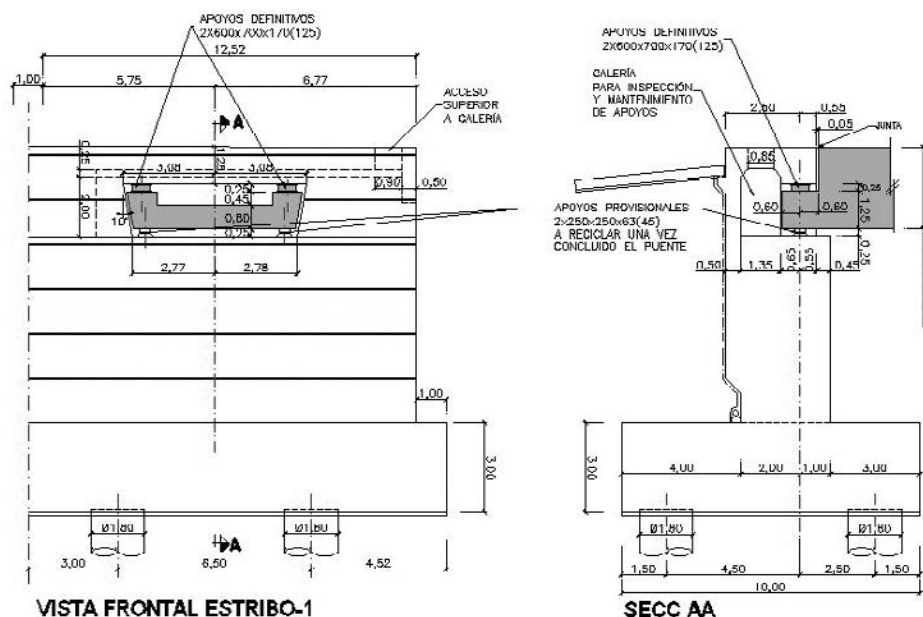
Vista del alzado y sección de los estribos con los detalles de los apoyos inversos.
